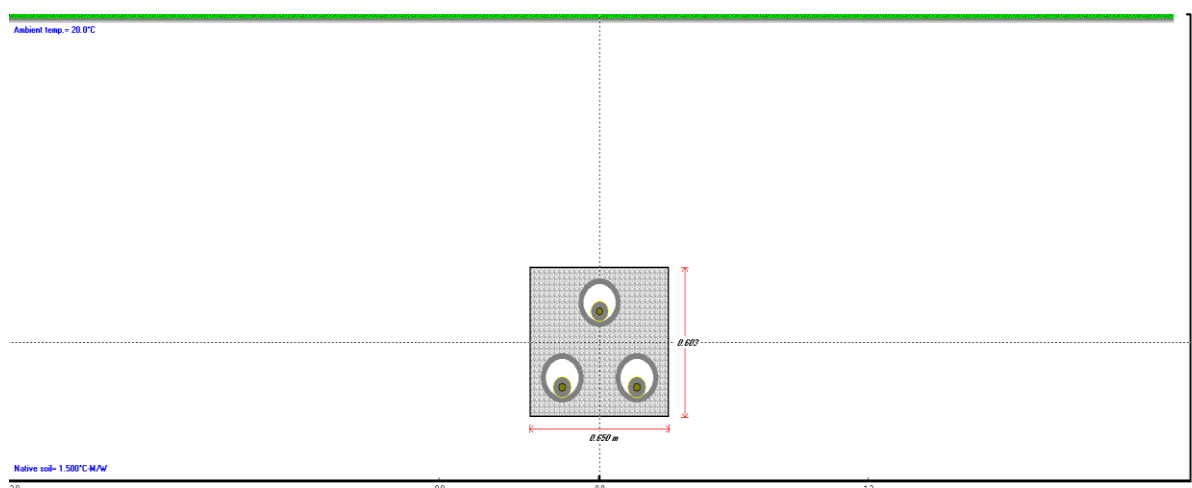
Ducto típico para ducto en concreto con tubería HDPE
